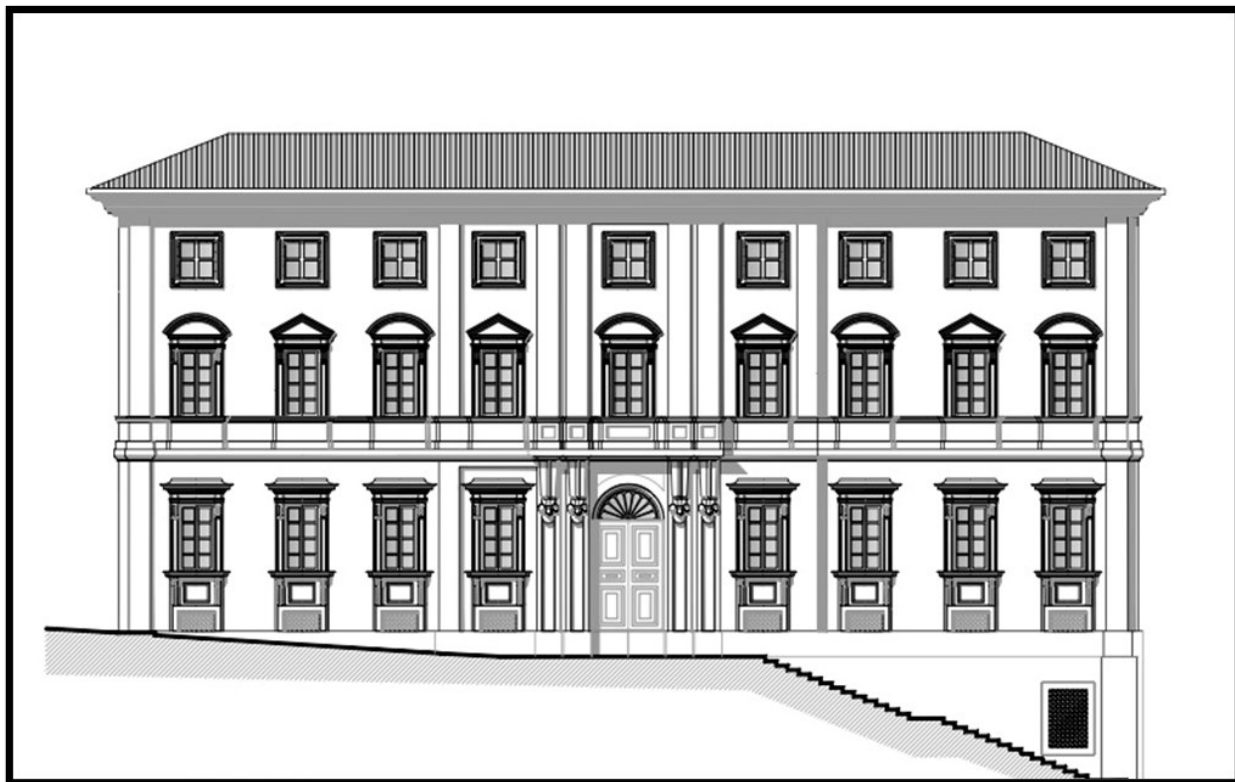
Prospetto del palazzo Buzi-Ceva (autore Stefano Di Lazzaro)
